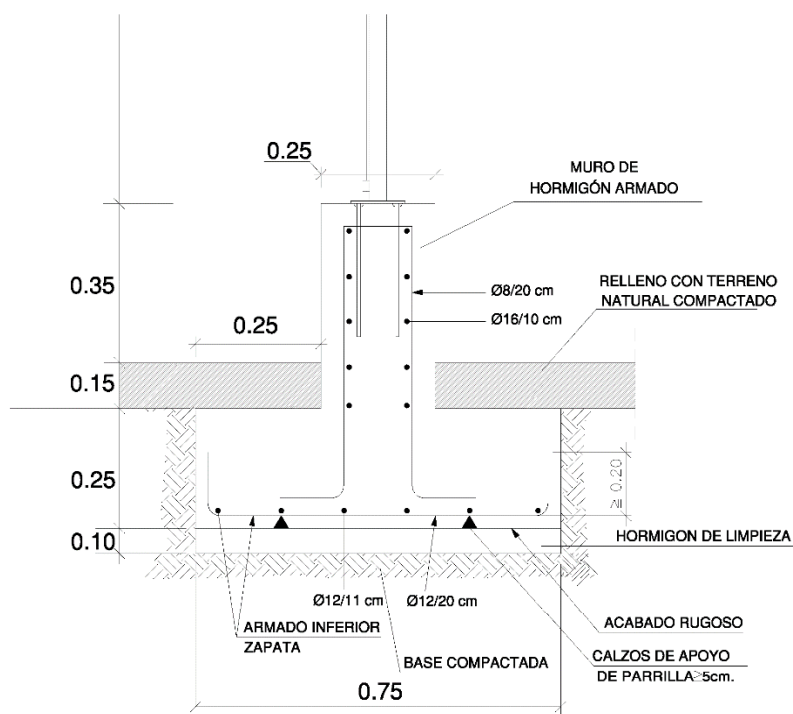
Detalle de murete de HA para vallado de cerramiento
